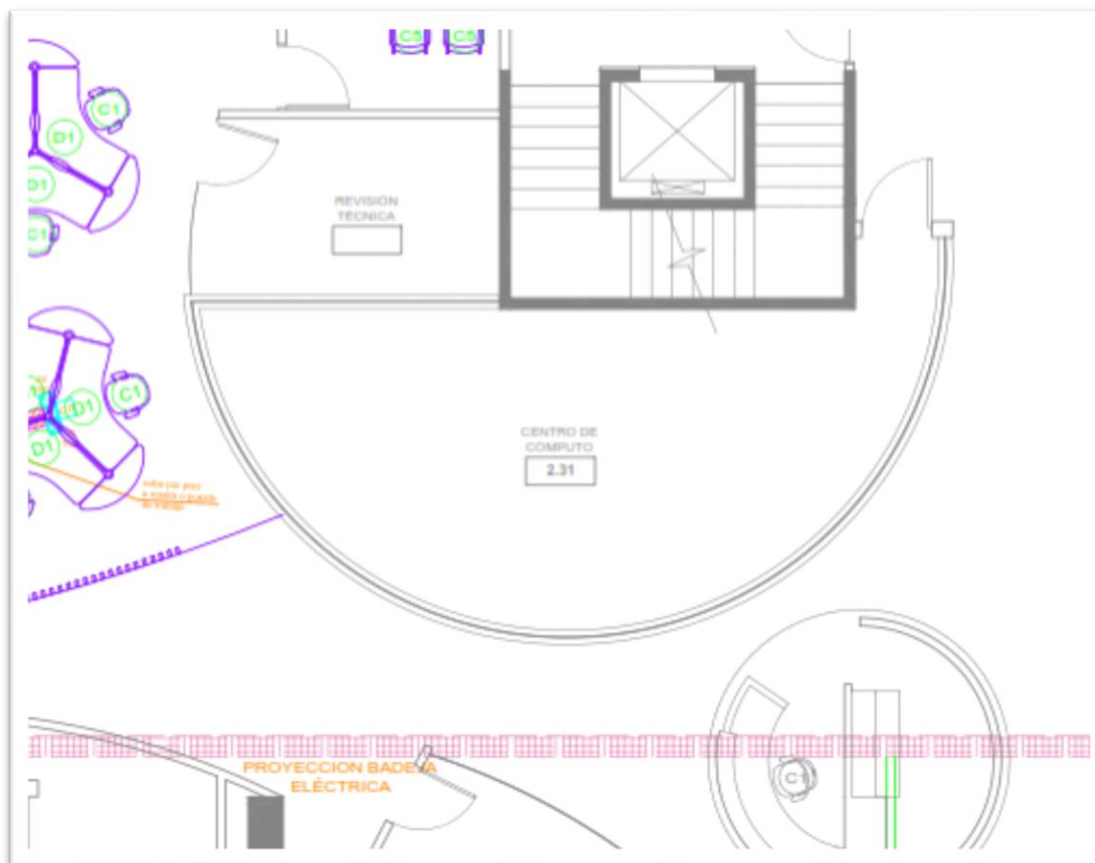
Plano de Zonas aledañas al CCP de la ANH
